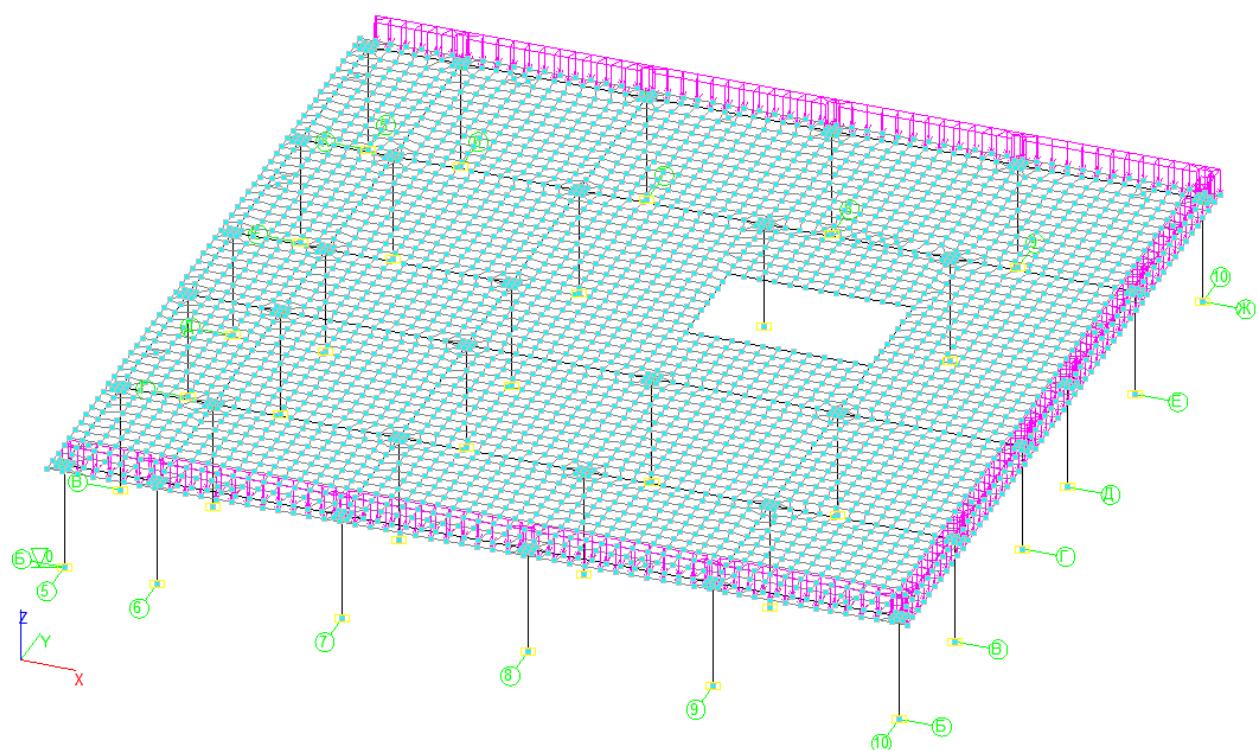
Общий вид постоянного загружения перекрытия от собственного веса наружной стены
